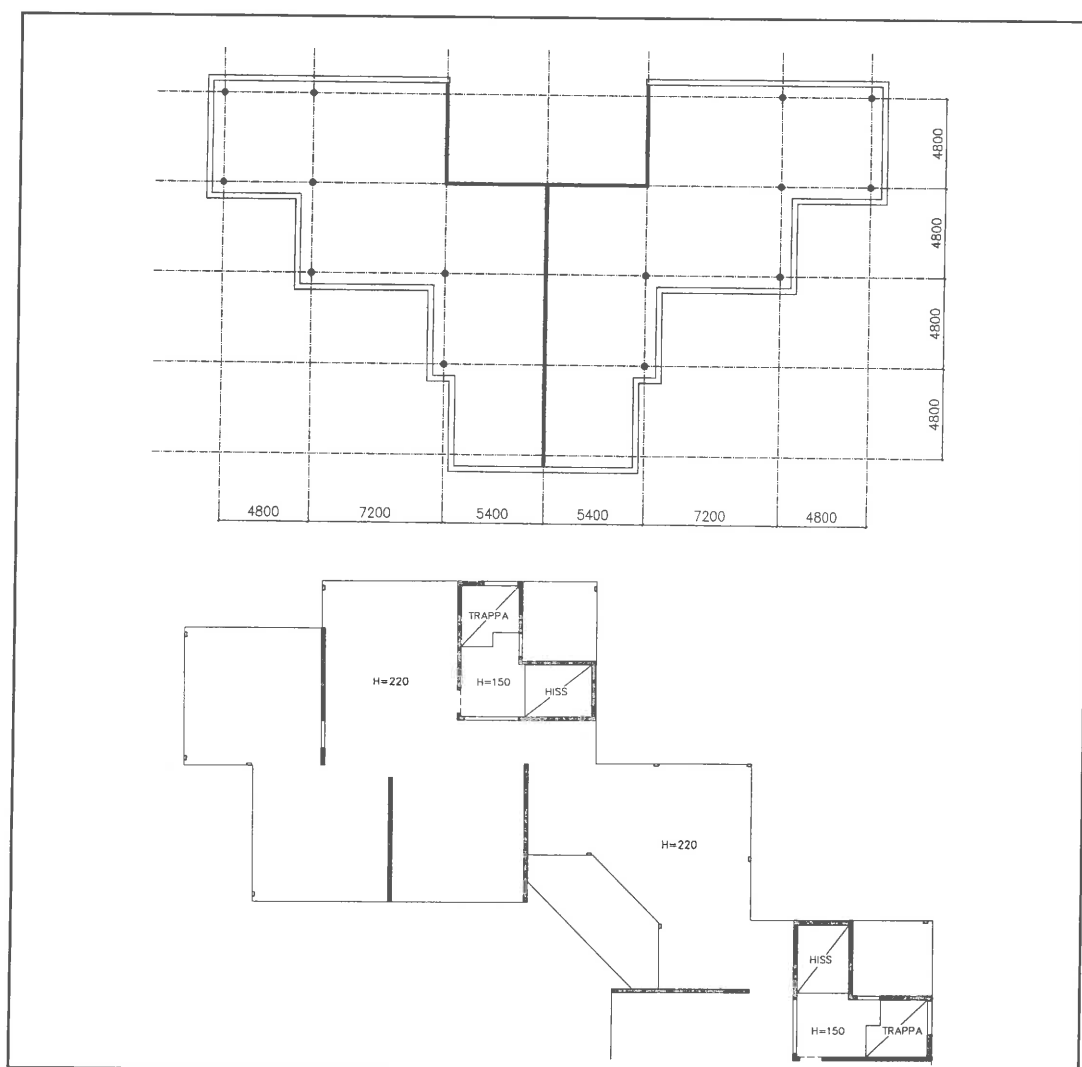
b. As Oy Helsingin Jaalapuisto. Runkovaihtoehtoja, joissa kantavia pystyrakenteina on käytetty pilareita eriasteisesti.
